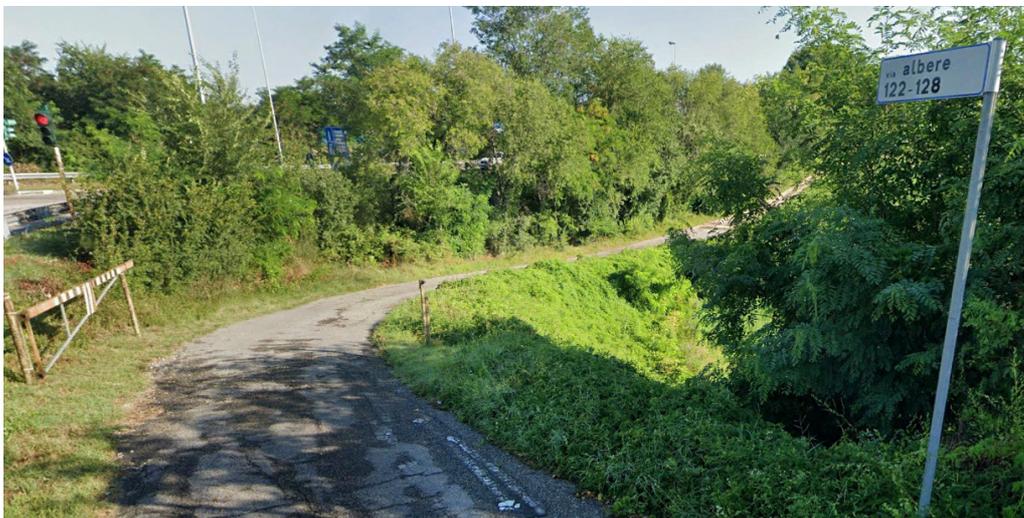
Vista della viabilità d'accesso al cantiere Via Albere
